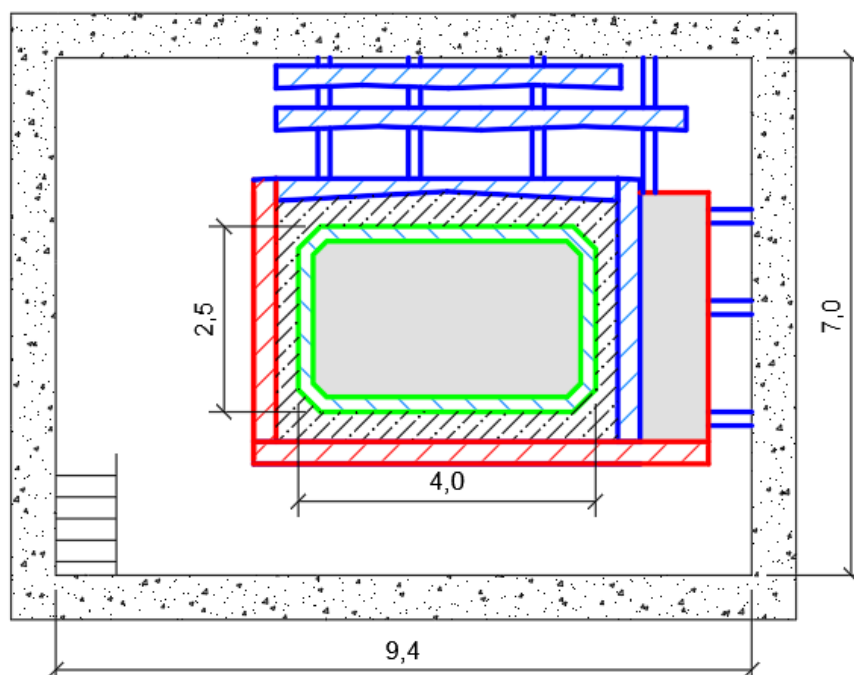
План предлагаемой пропарочной камеры в момент изготовления одного железобетонного прямоугольного звена водопропускной трубы прямоугольного сечением 4,0x2,5м на Стенде.
